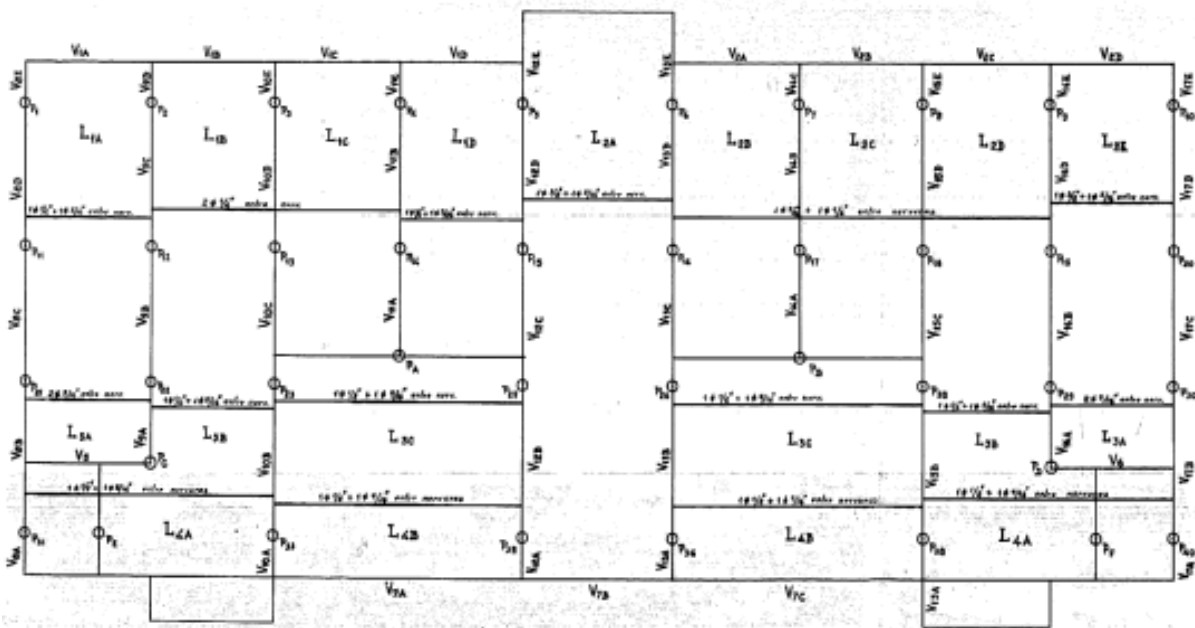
Planta estrutural do tecto tipo do bloco de Costa Cabral
